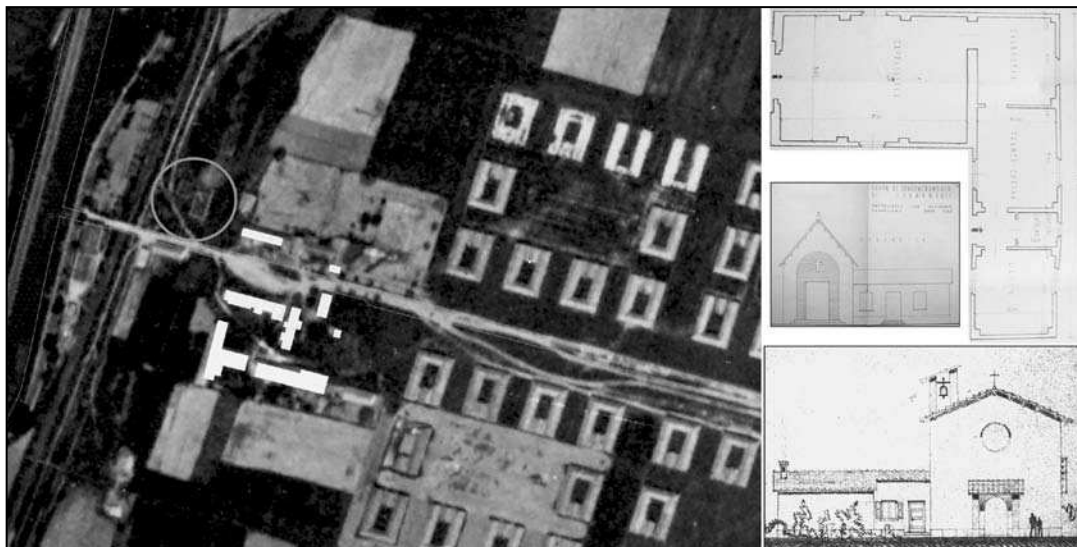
Le fondazioni della chiesa cattolica nell'aerofotografia del 1953 ed il suo progetto originale (concessione Aerofototeca Nazionale Ripresa ETA 1953 229 neg. 7640, Concessione MiBac Archivio Centrale dello Stato, autorizzazione n° 1063/2013).
